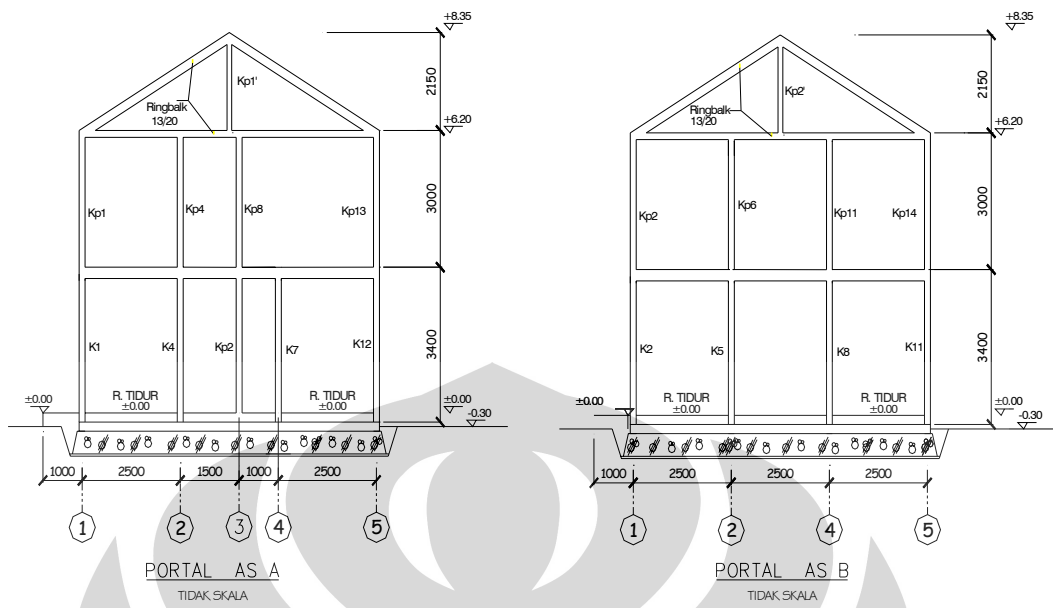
Bentuk struktur model satu pada bangunan dua lantai
